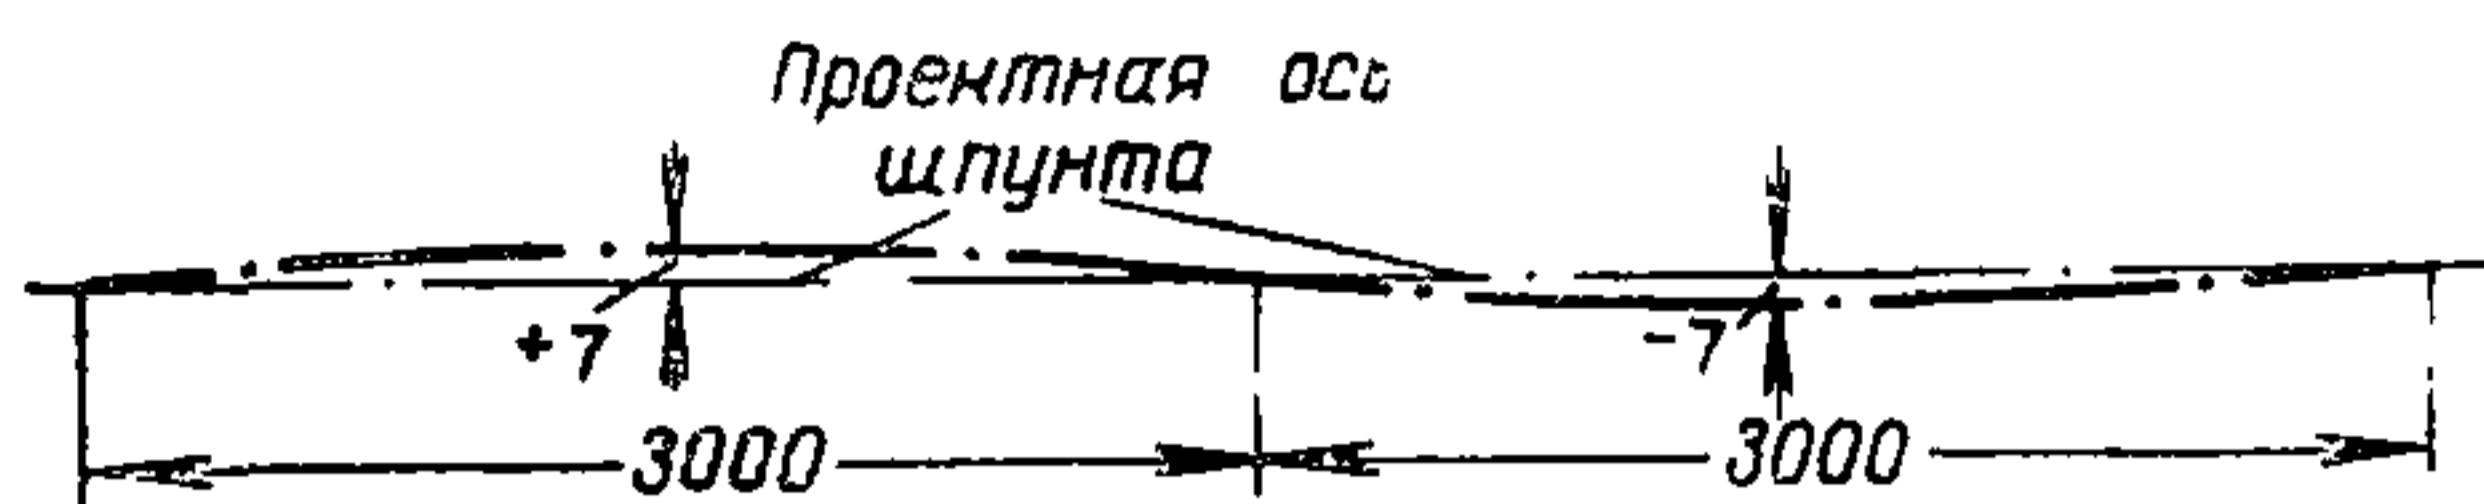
Допускаемое отклонение (см) оси шпунтовой стенки от проектной на уровне верха шпунта
